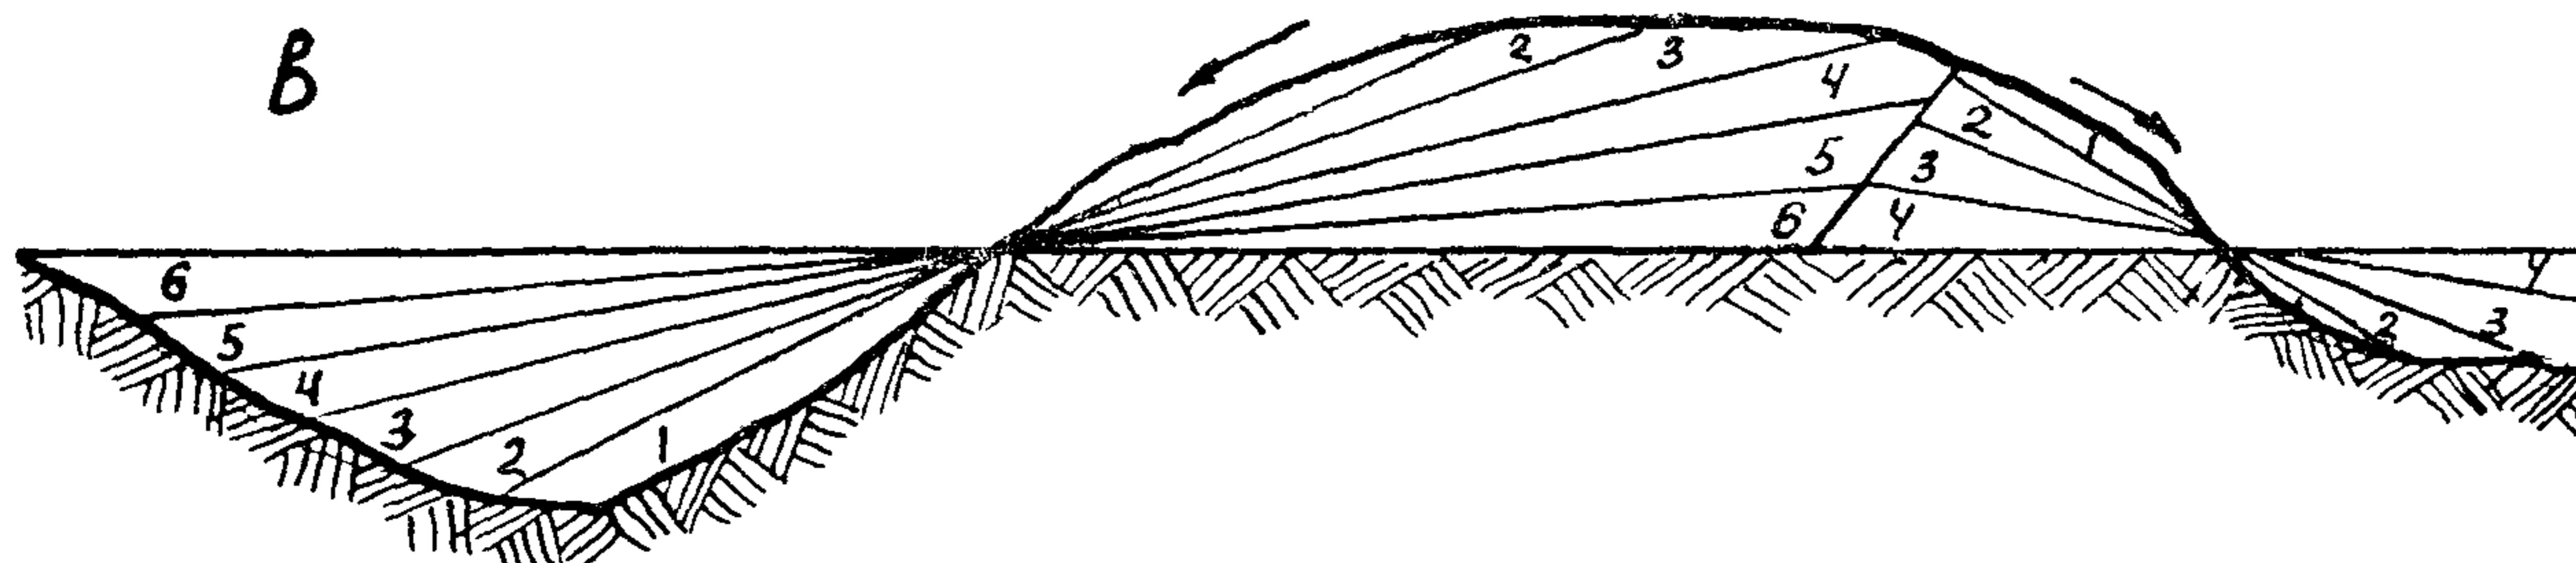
Разработка выемки с перемещением грунта в две насыпи
